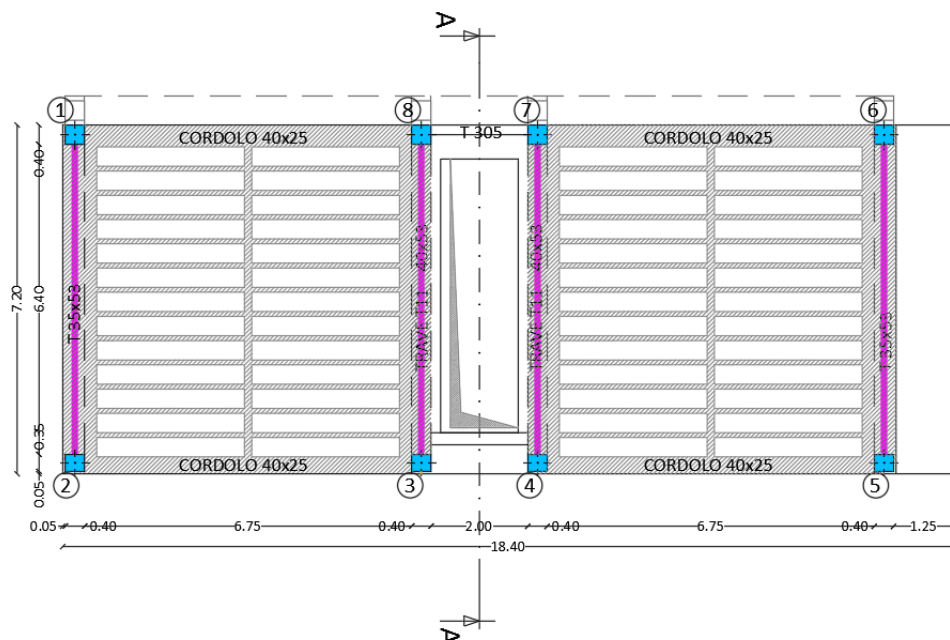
Planimetria Piano Copertura del corpo Q con indicazione in colore magenta dei rinforzi in acciaio.
